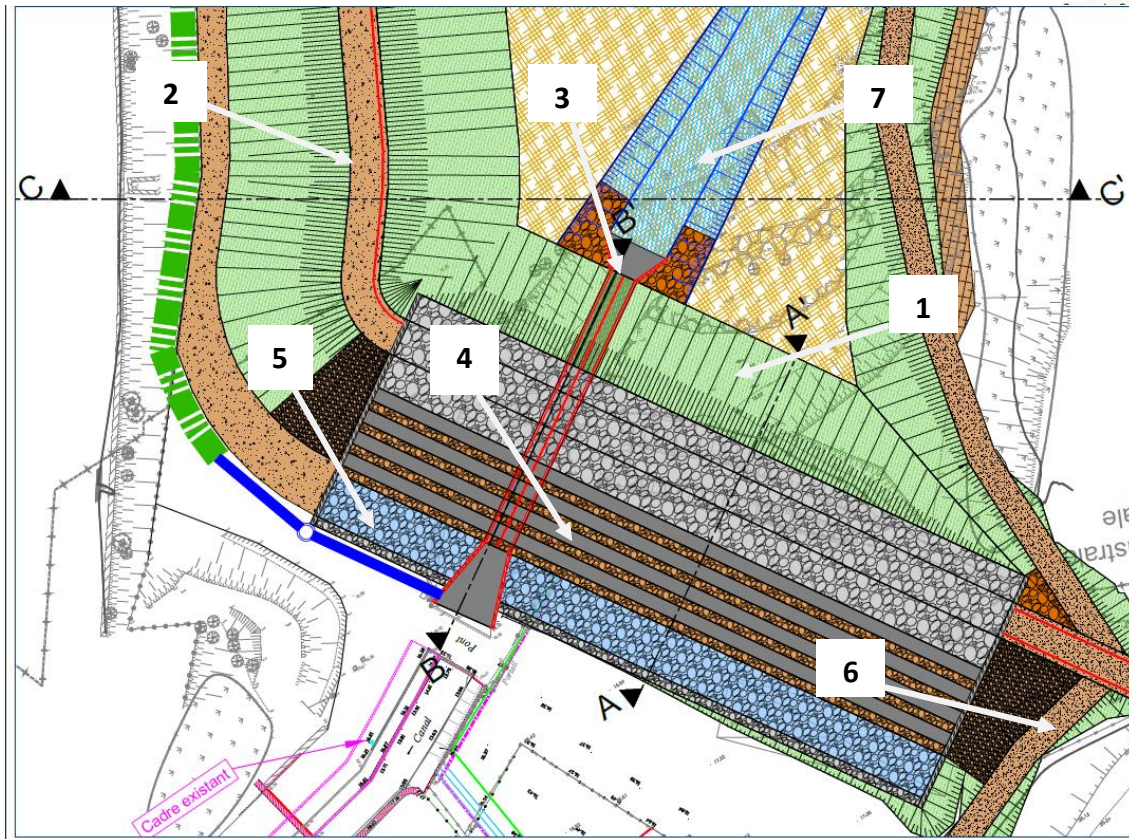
Localisation des coupes sur la section courante et sur la section déversante de l'aménagement hydraulique – plan AVP
